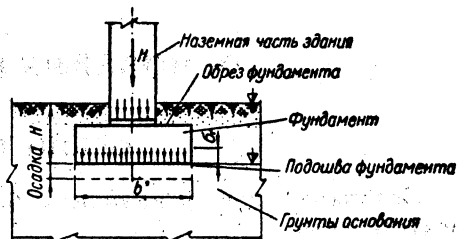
Схема передачи нагрузки на грунт под подошвой и осадка основания.
